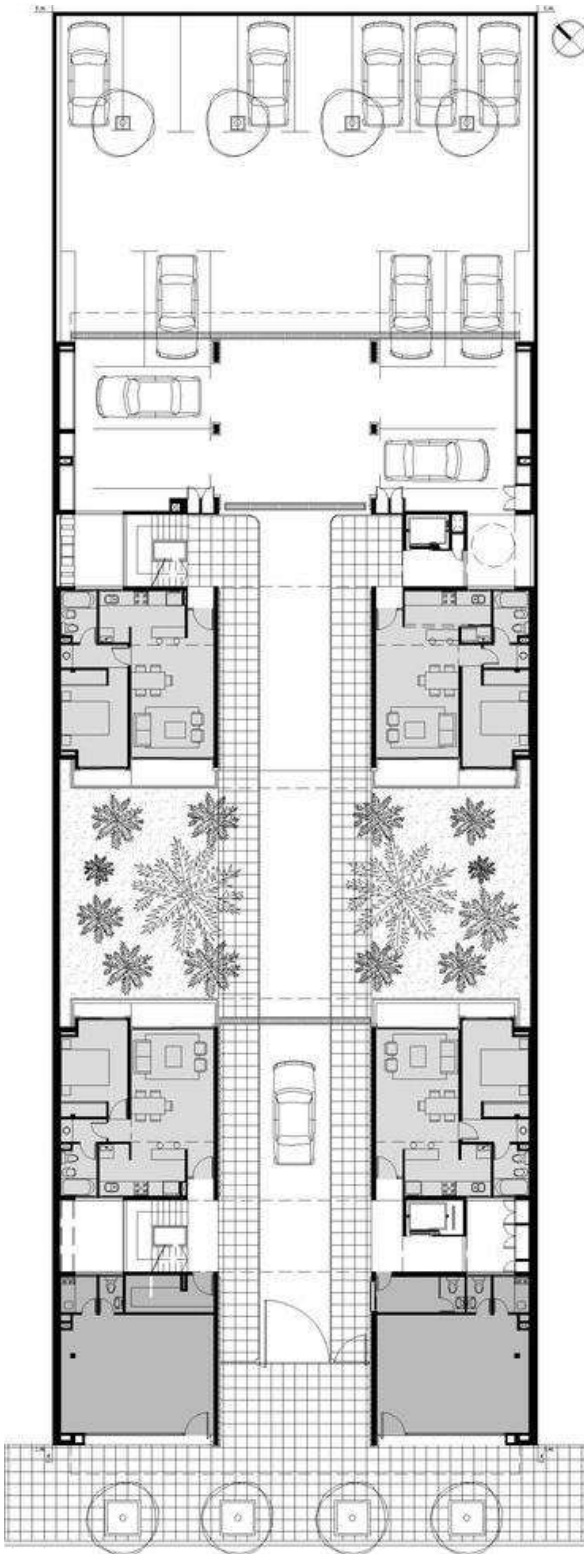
"Planta Nivel 1" Edificio 5#522 ,
